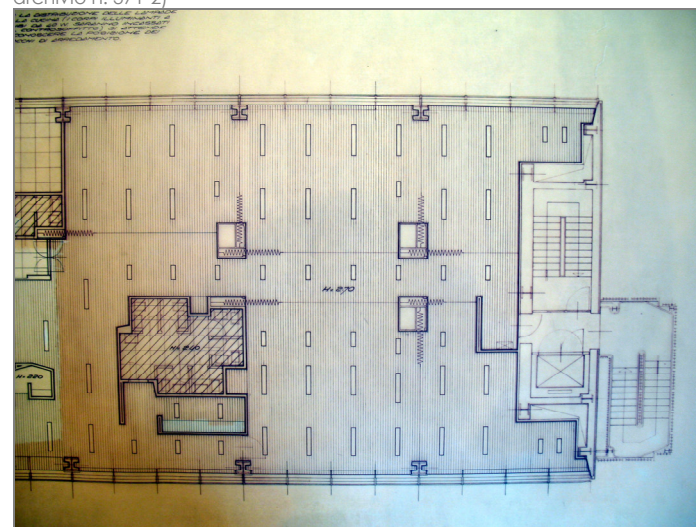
proposta di ristrutturazione generale - pianta piano 19° – controsoffitto e disposizione lampade (fonte CSAC , stralcio tav. 16, archivio n. 371-2)
